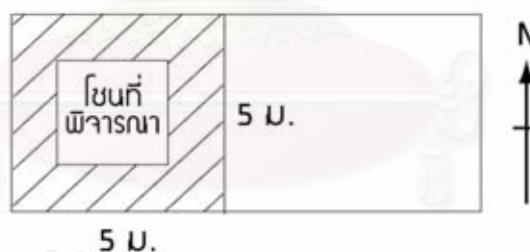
Floor Plan แสดงลักษณะของโฉนตัวอย่างที่ 3
